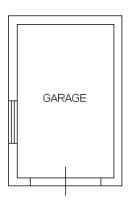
Estratto planimetria catastale, relativa al garage
